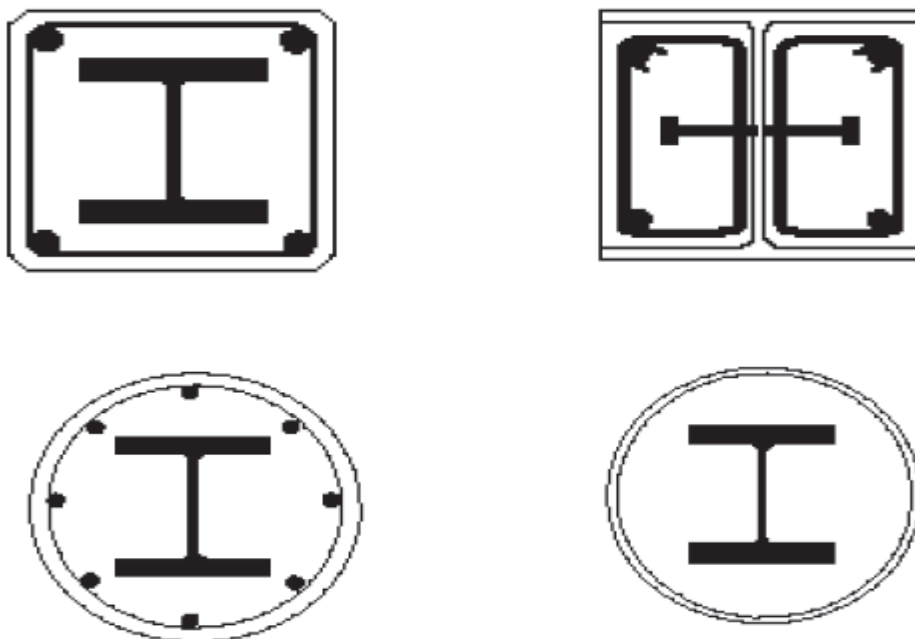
Exemples de sections transversales des poteaux mixtes. [2]
